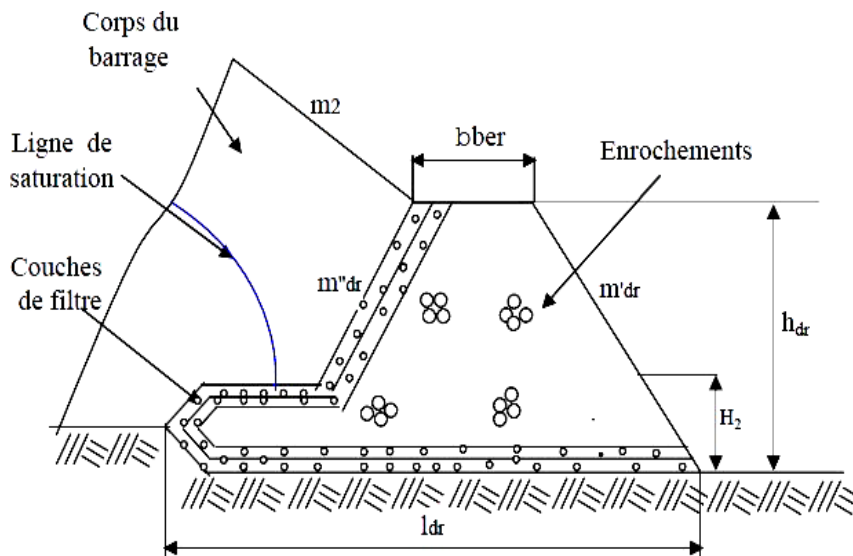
Prisme de drainage avec drain tapis interne sur fondations perméables.
